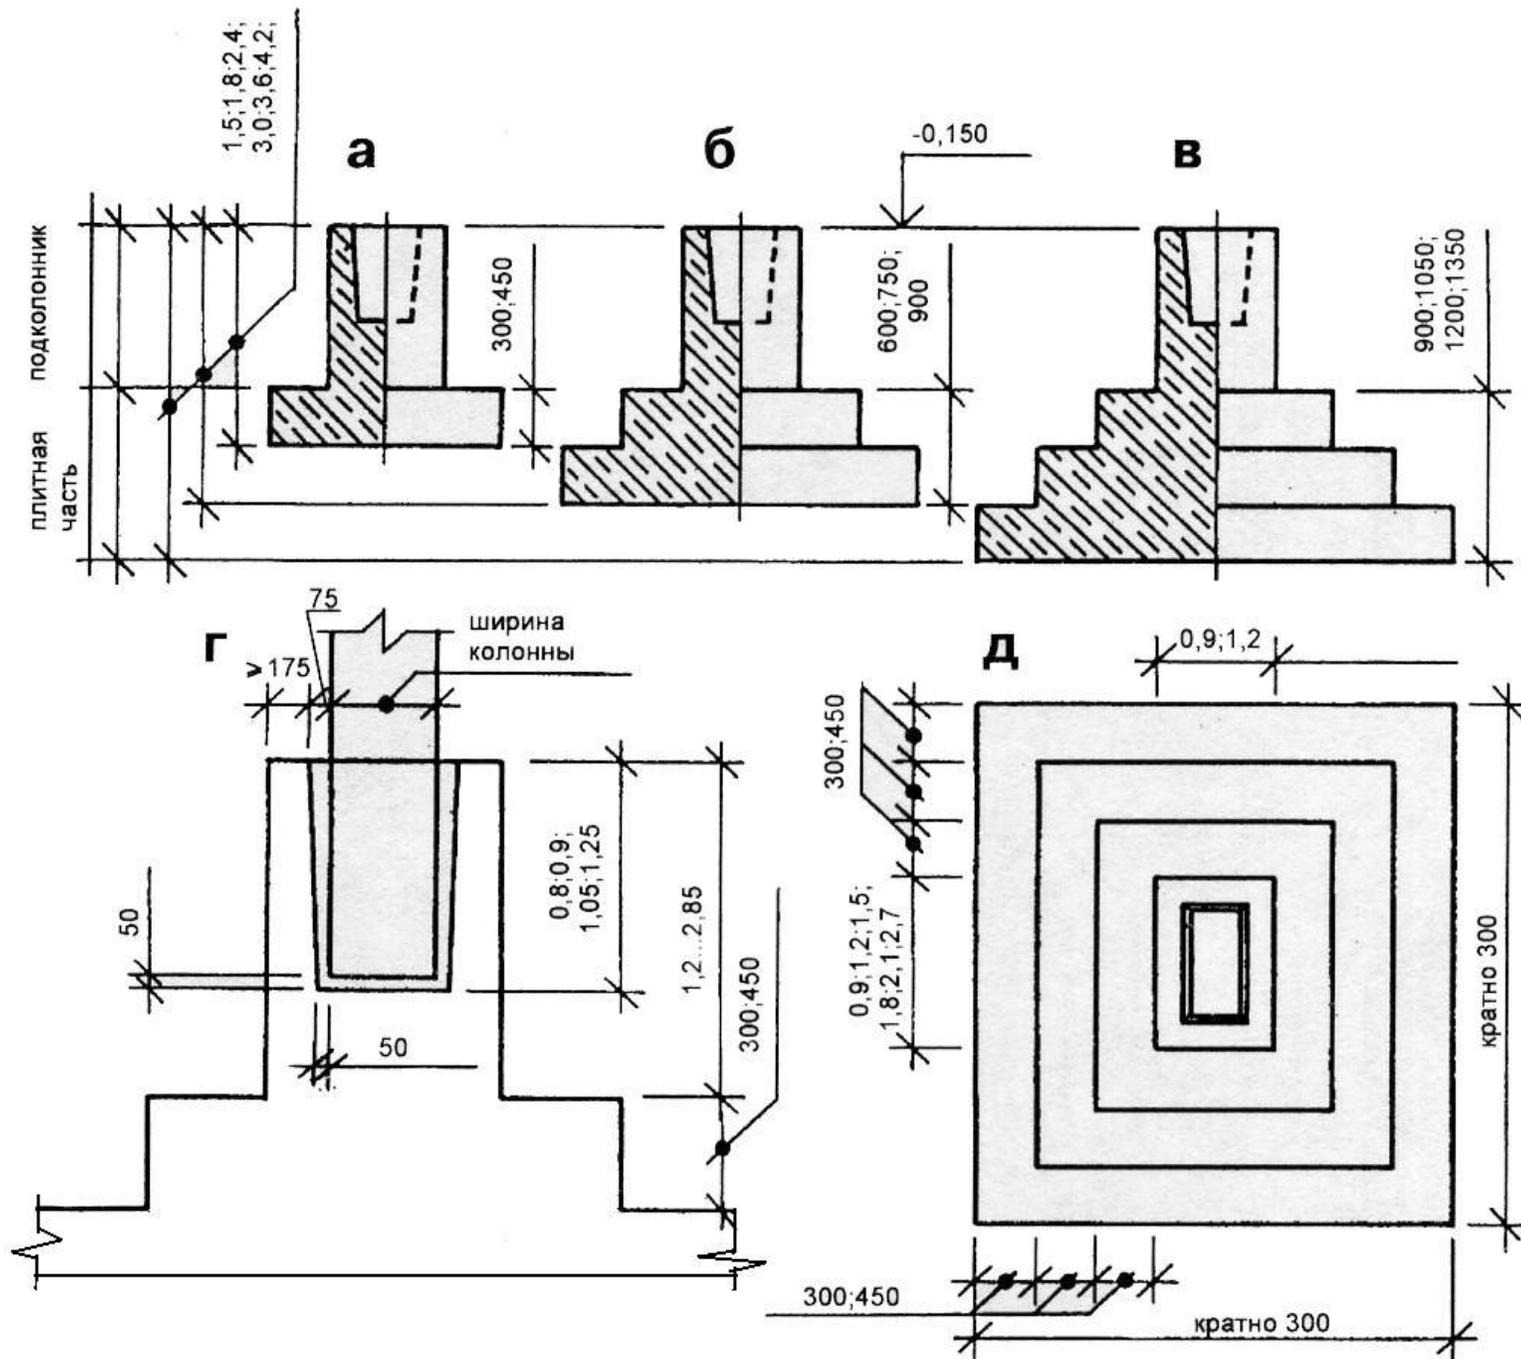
Монолитный железобетонный фундамент стаканного типа под сборную колонну:
